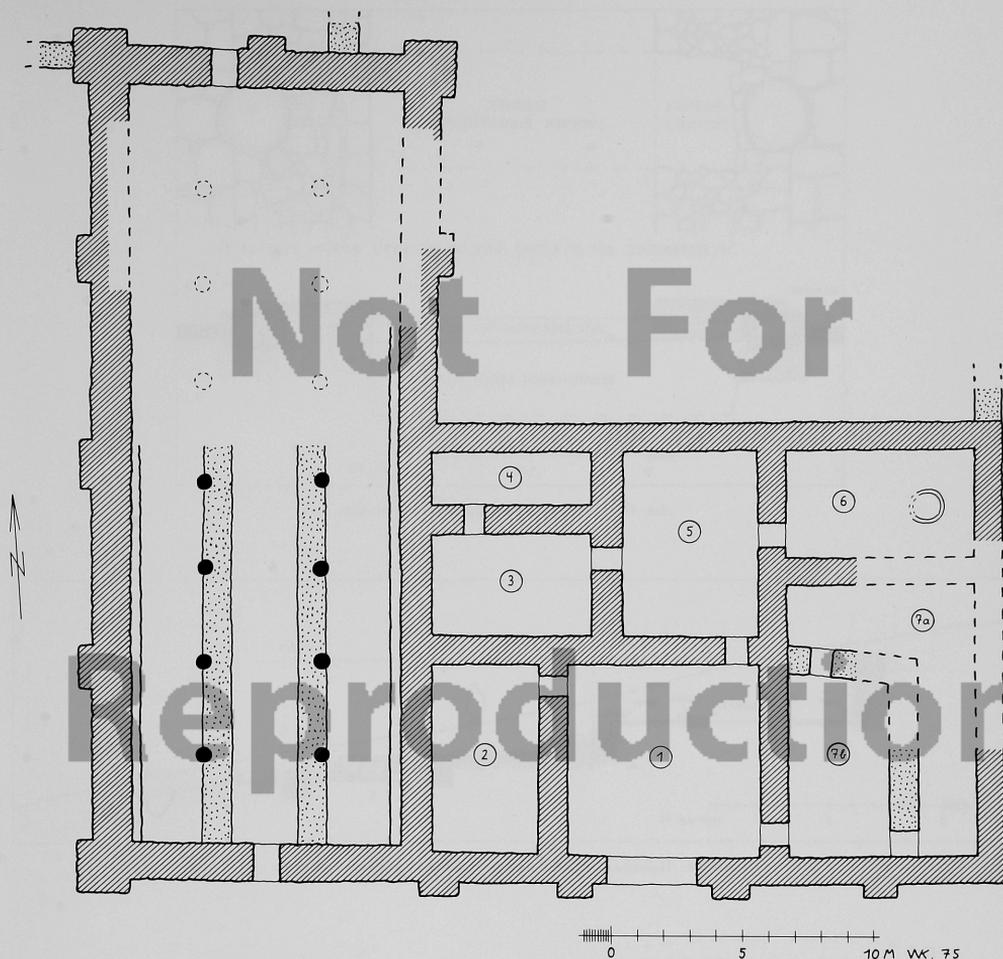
Hallenbau, ursprünglicher Plan mit Angabe der jüngeren urartäischen Veränderungen
